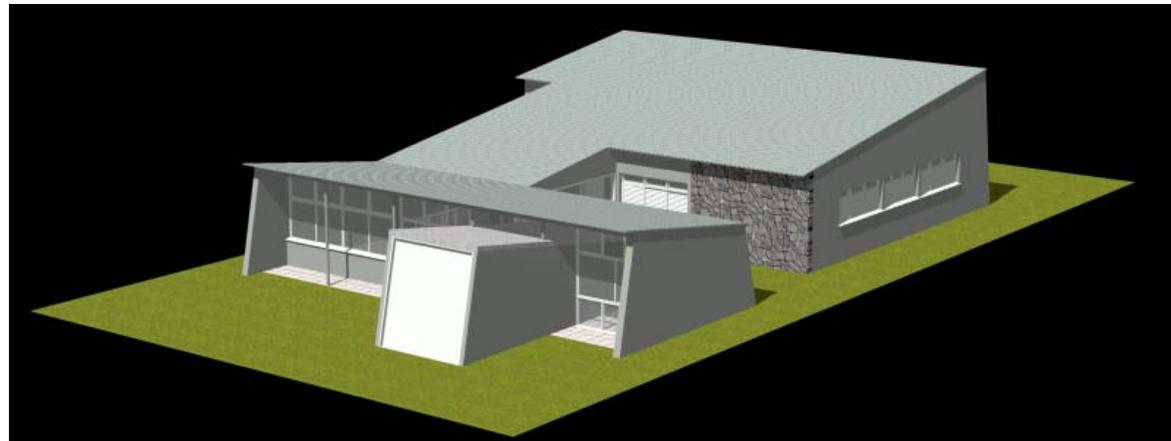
Casa Manoel Affonso Ferreira Filho, 1948 – imagens de maquete eletrônica
